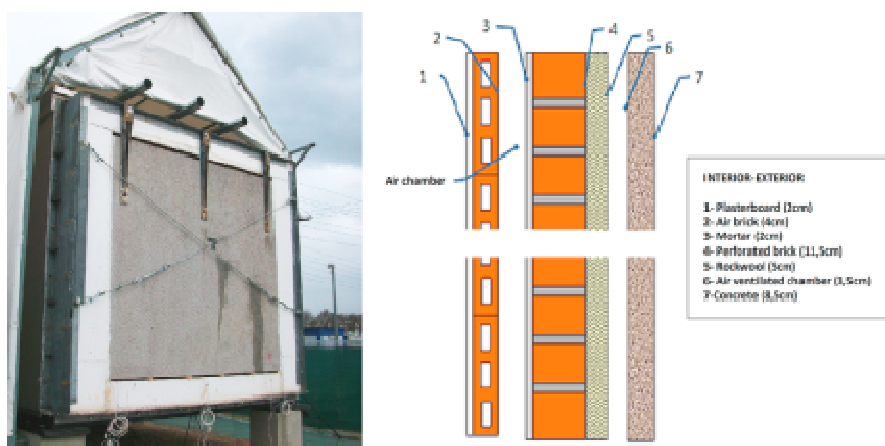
Solución pesada en la celda de ensayos (izquierda) y esquema de su solución constructiva (derecha)
